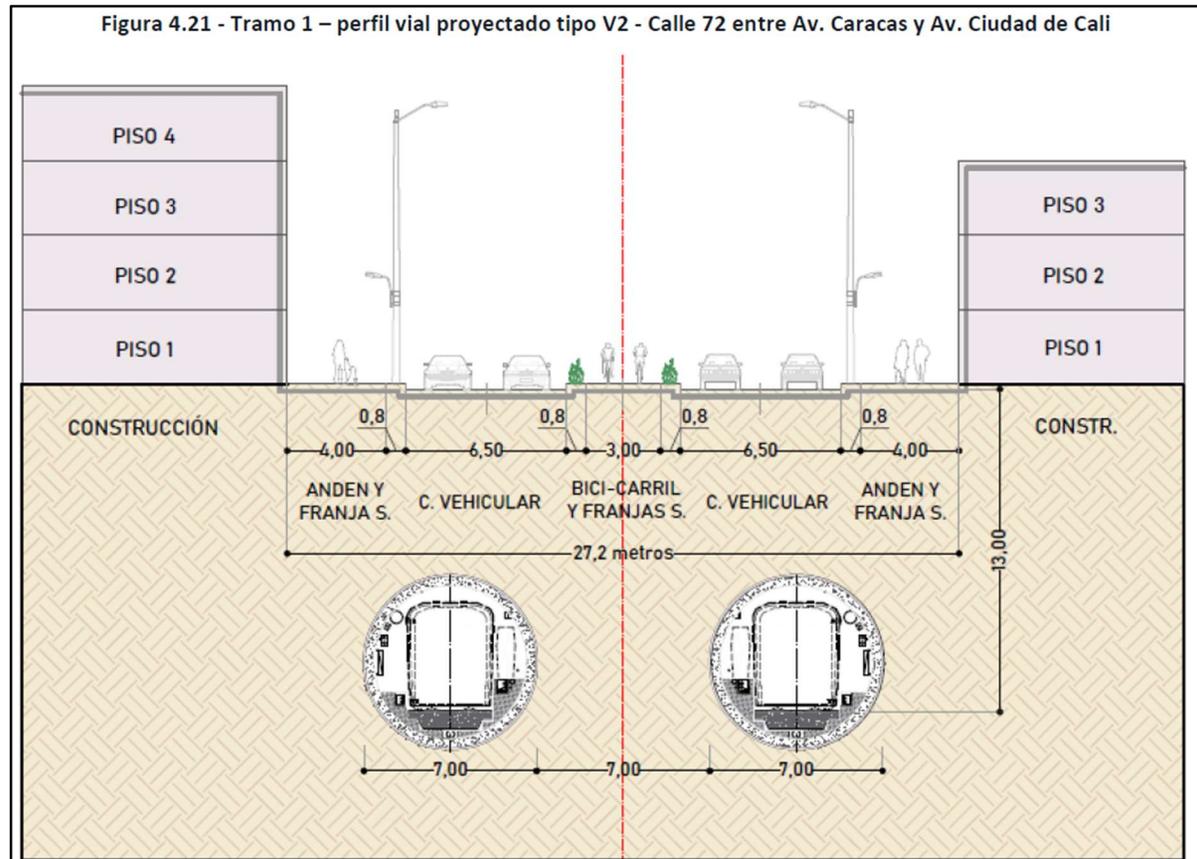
Tramo 1 - Perfil vial proyectado tipo V2 - Calle 72 entre Av. Caracas y Av. Ciudad de Cali
